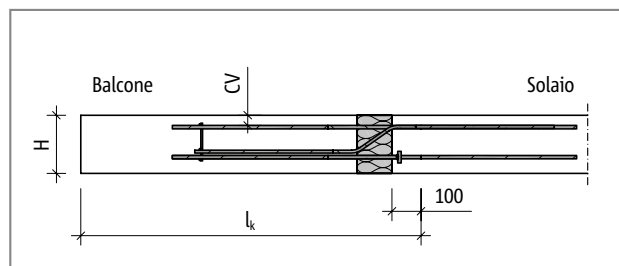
Schöck Isokorb® tipo EXT: sistema statico
